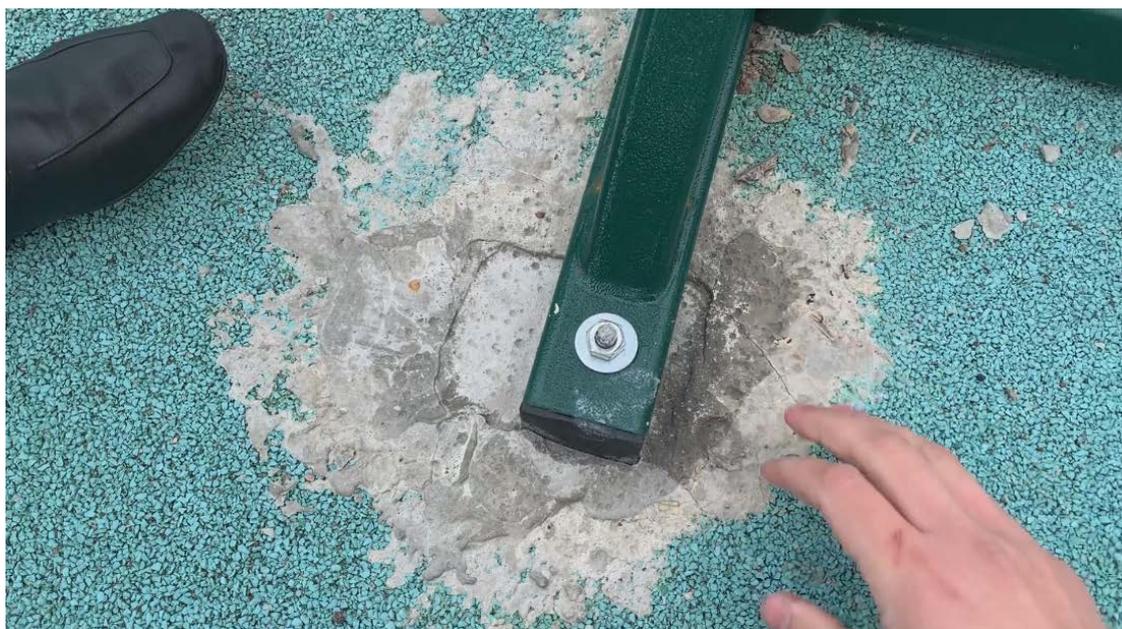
Крепление опорной конструкция тренажерного комплекса к закладным деталям фундамента смонтированного на площадке №2 у тренажера маятник. Места примыкания универсального покрытия к блоку фундамента залиты цементным раствором поверх универсального покрытия. Видимых мест просадки оснований, деформации или разрывов универсального покрытия в зоне установки фундаментного блока не выявлено.
